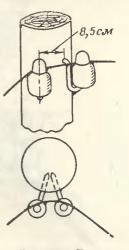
Двойчое крепление провода на штыревых изоляторах на крюках угловой опоры.
